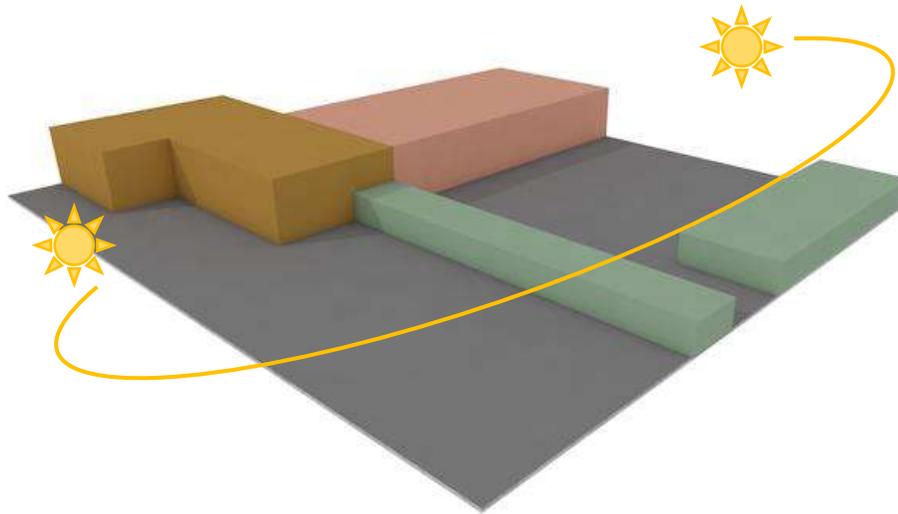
Volúmenes propuesto para proyecto arquitectónico, elaboración propia.
